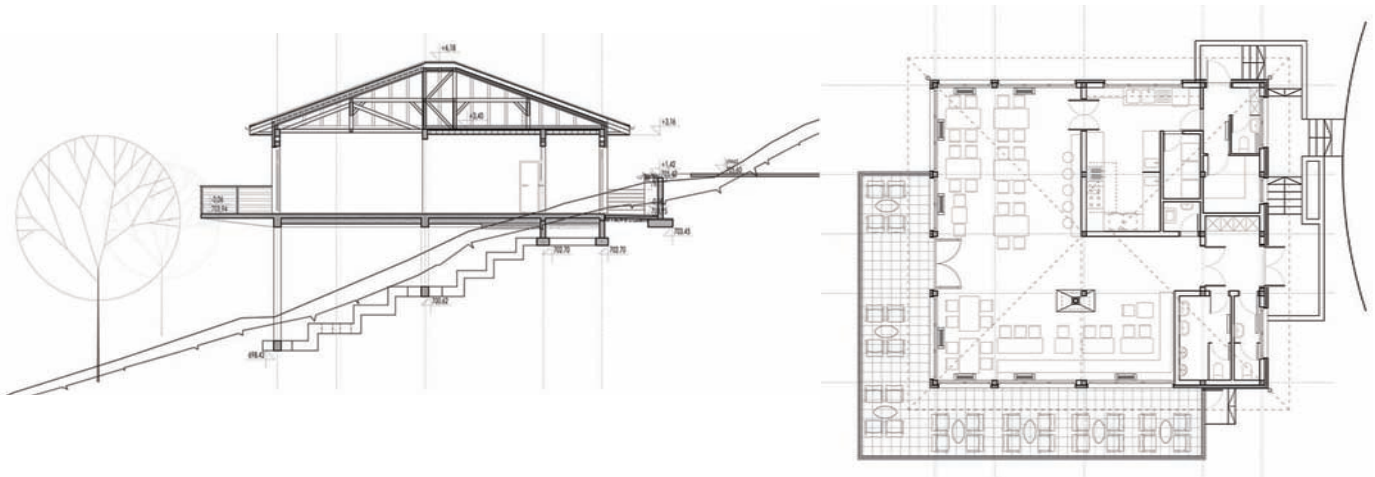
Основа и пресек главног објекта / Fig. 8. Ground floor and section of the main building
